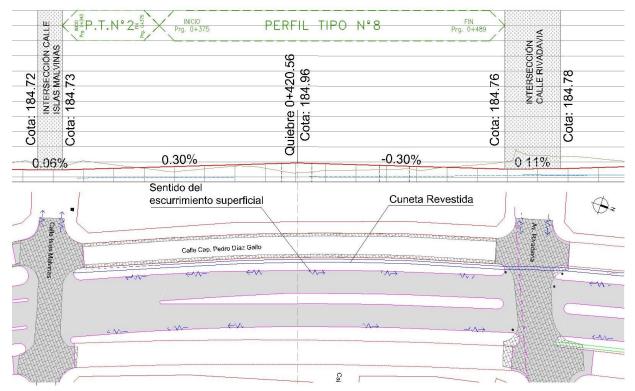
Planialtimetría de Av. Lugones Norte entre calle Islas Malvinas y Rivadavia. El drenaje se muestra en azul.
